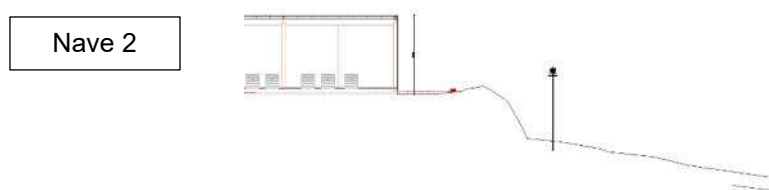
Talude 2 – Corte transversal ilustrando a situação sem proposta de reperfilamento.
